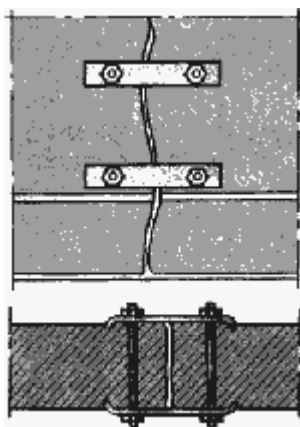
Усиление кирпичной стены металлическими накладками при разрыве стены.
